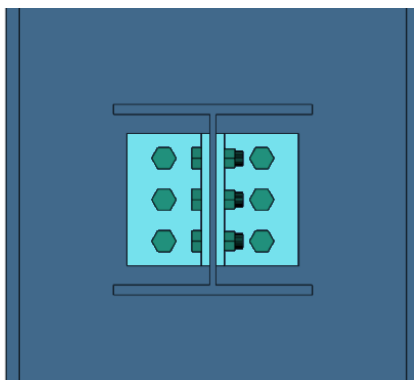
Articulation poteau-poutre par cornières boulonnées sur l'âme du poteau - vue de face
